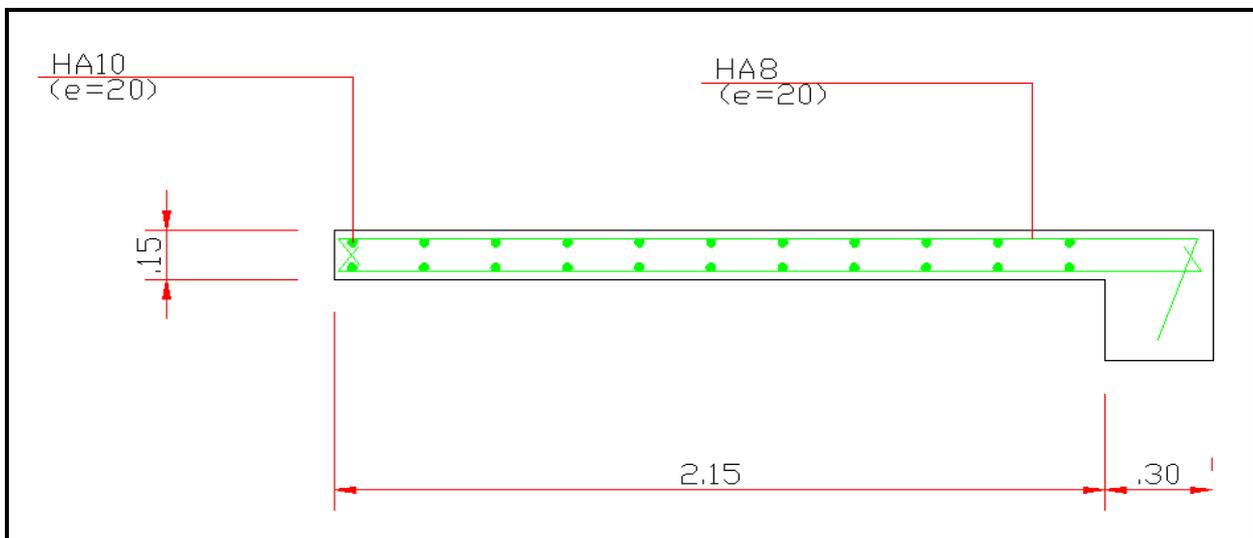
ferrailage balcon 01 (coupe A-A).
